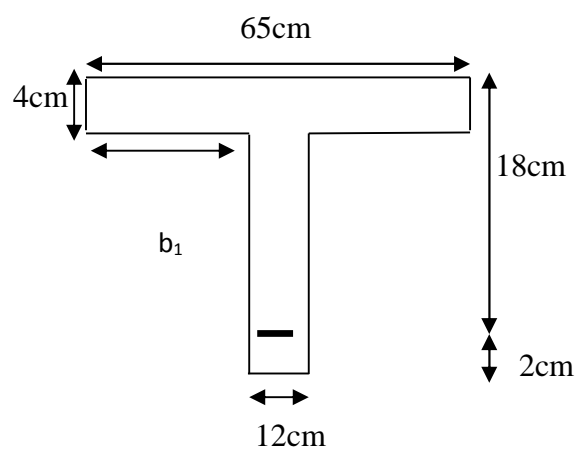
section de la poutrelle après coulage de la dalle de compression.
